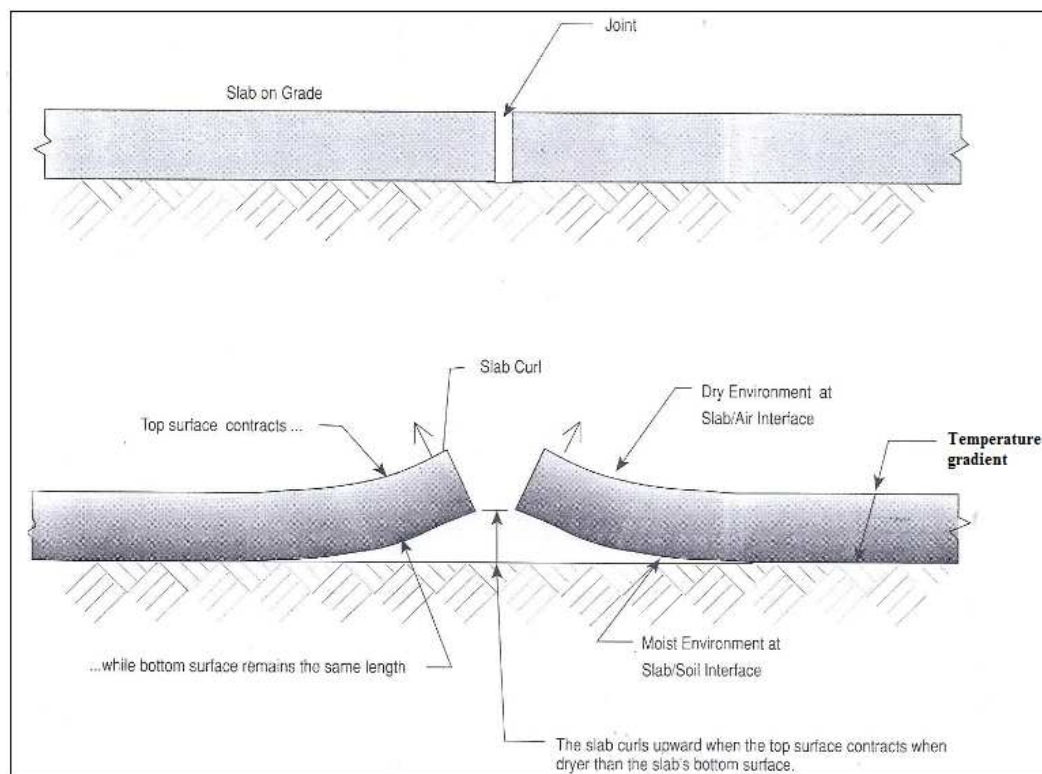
Empenamento de lajes de concreto, ao se dilatarem. Fonte: adaptado de Emmons (1993).
